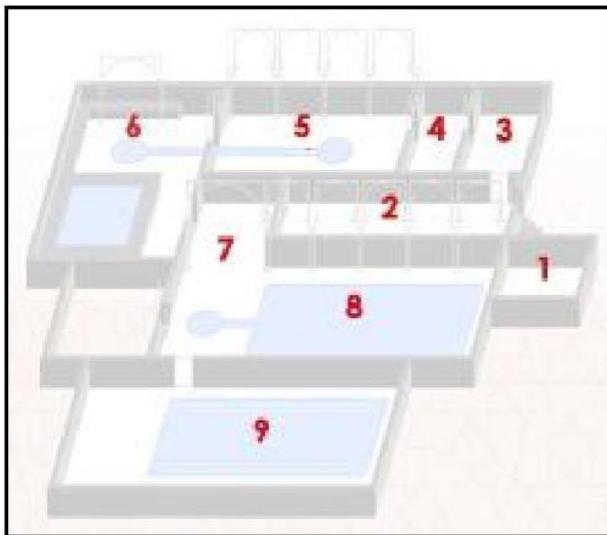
plans d'un bain arabe Source :www.bain arabe .com
